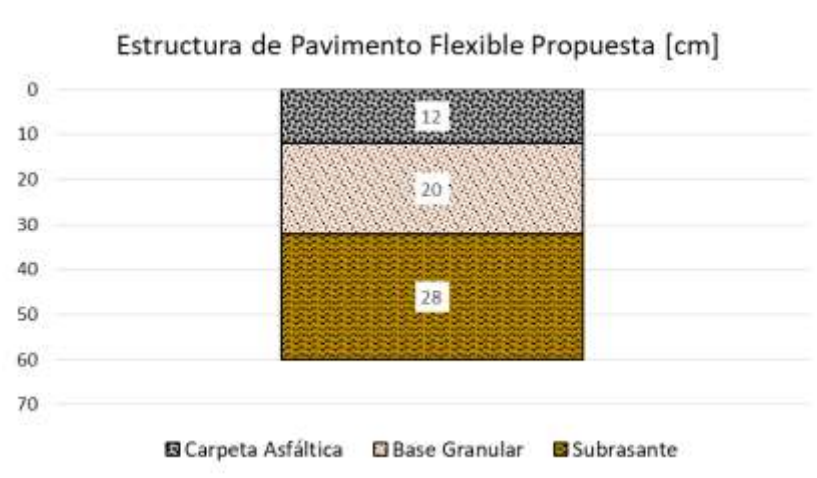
Estructura de Pavimento Flexible Propuesta
